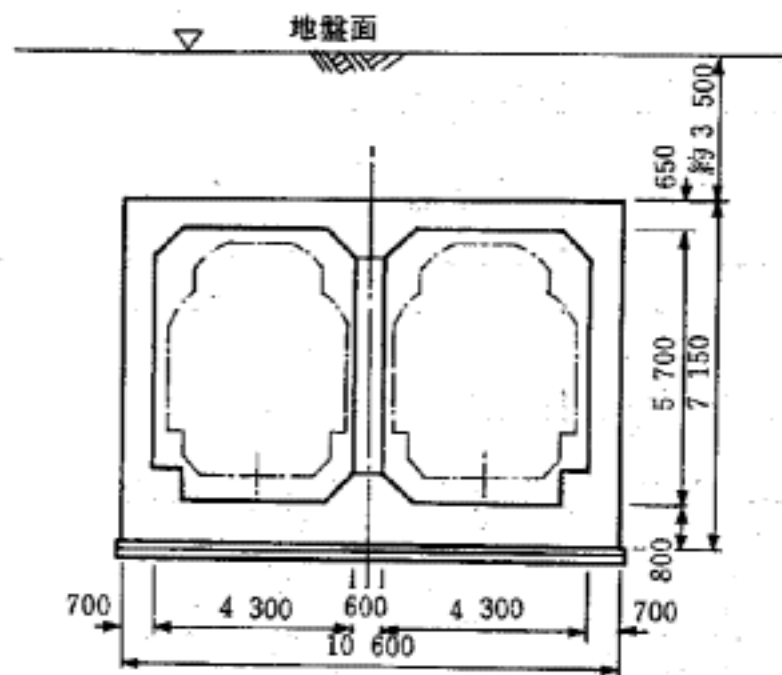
2 - 3 鉄筋コンクリート箱形トンネル標準断面図 (A - A 断面) (単位 : mm)
